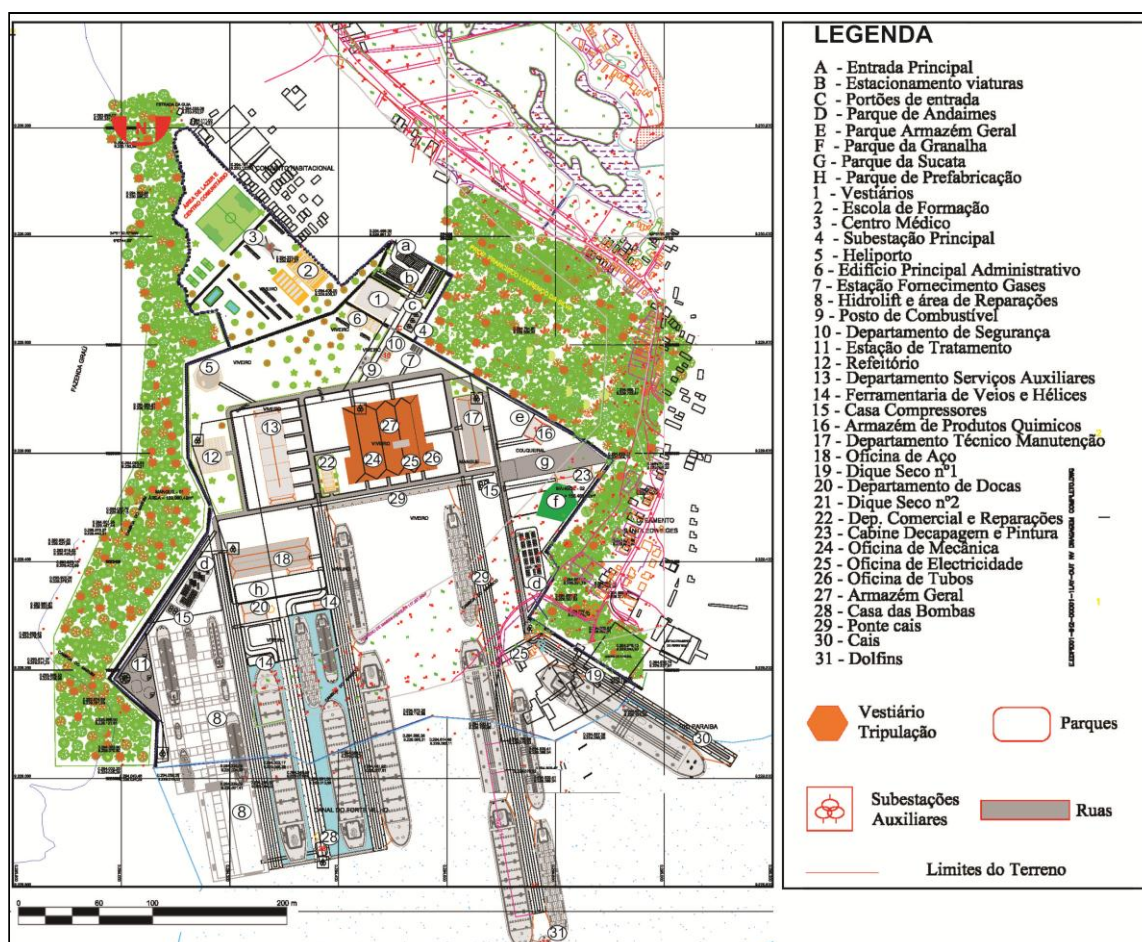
Layout do Empreendimento EPDI - (Fonte. McQuilling Partners, Inc.).
